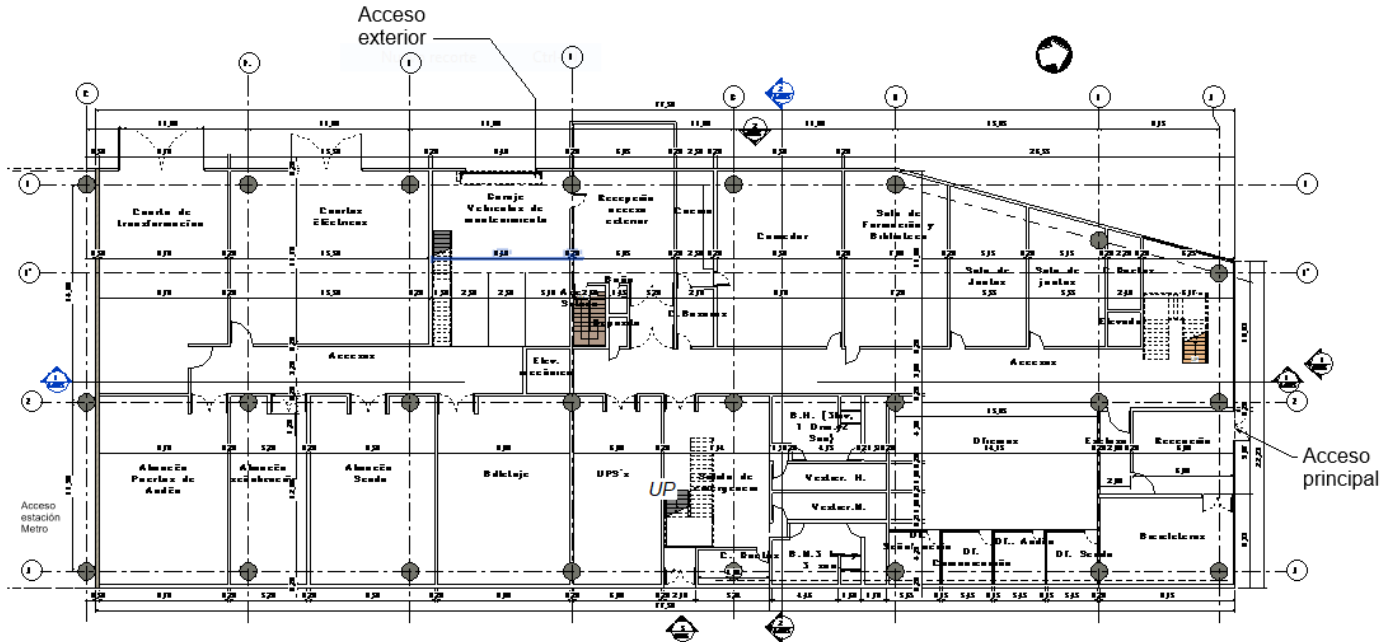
Planta arquitectónica primer piso. Fuente: Elaboración propia
